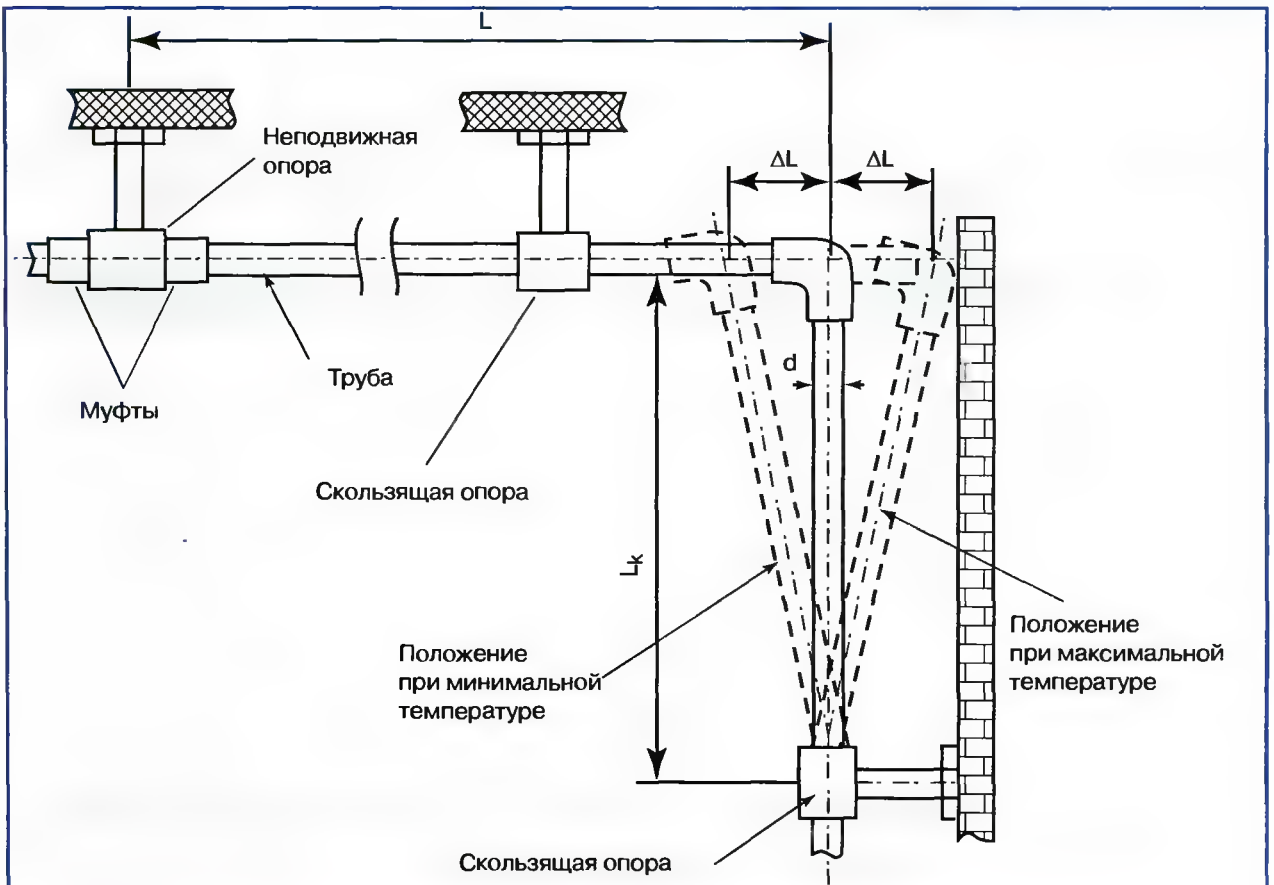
Г-образный компенсатор для полипропиленовой трубы
